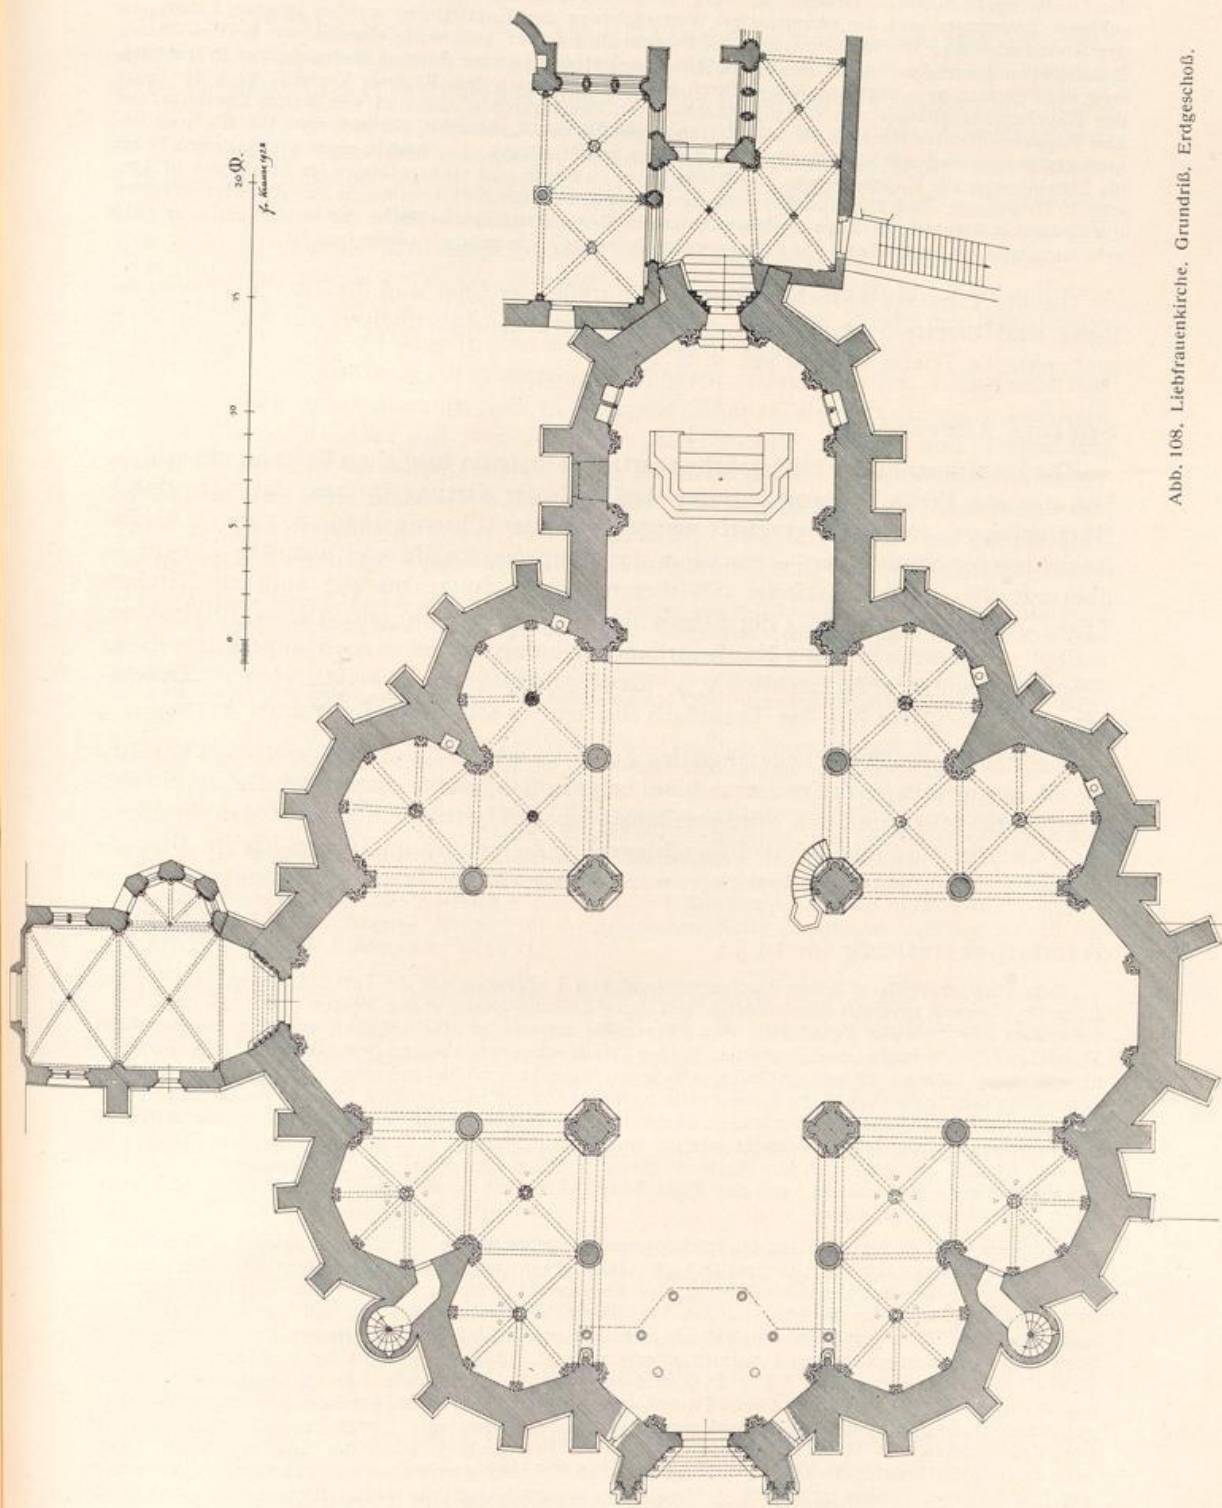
Liebfrauenkirche. Grundriß, Erdgesch. 6.
